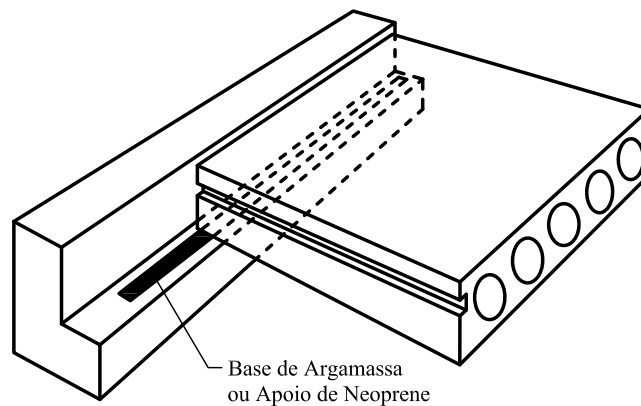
Ligação laje - viga simplesmente apoiada, adaptado de [6]
